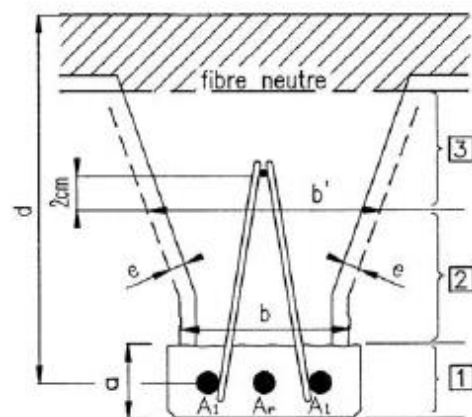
Schéma statique de la poutrelle en treillis.
